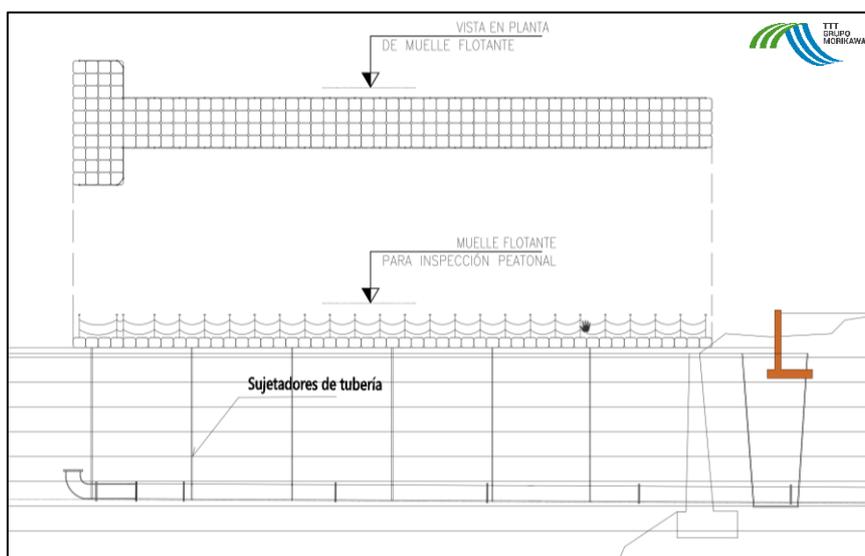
VISTA EN PLANTA Y ELEVACIÓN DE MUELLE FLOTANTE / FUENTE: PROPIA
